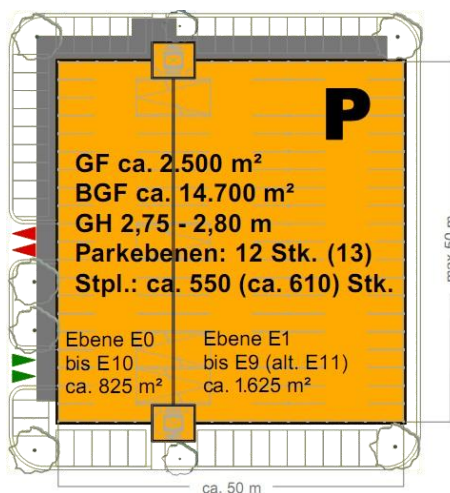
Grundriss Parkhaus-Erdgeschoss (Ebenen E0 und E1) aus SWM PH Konzept Lageplan
